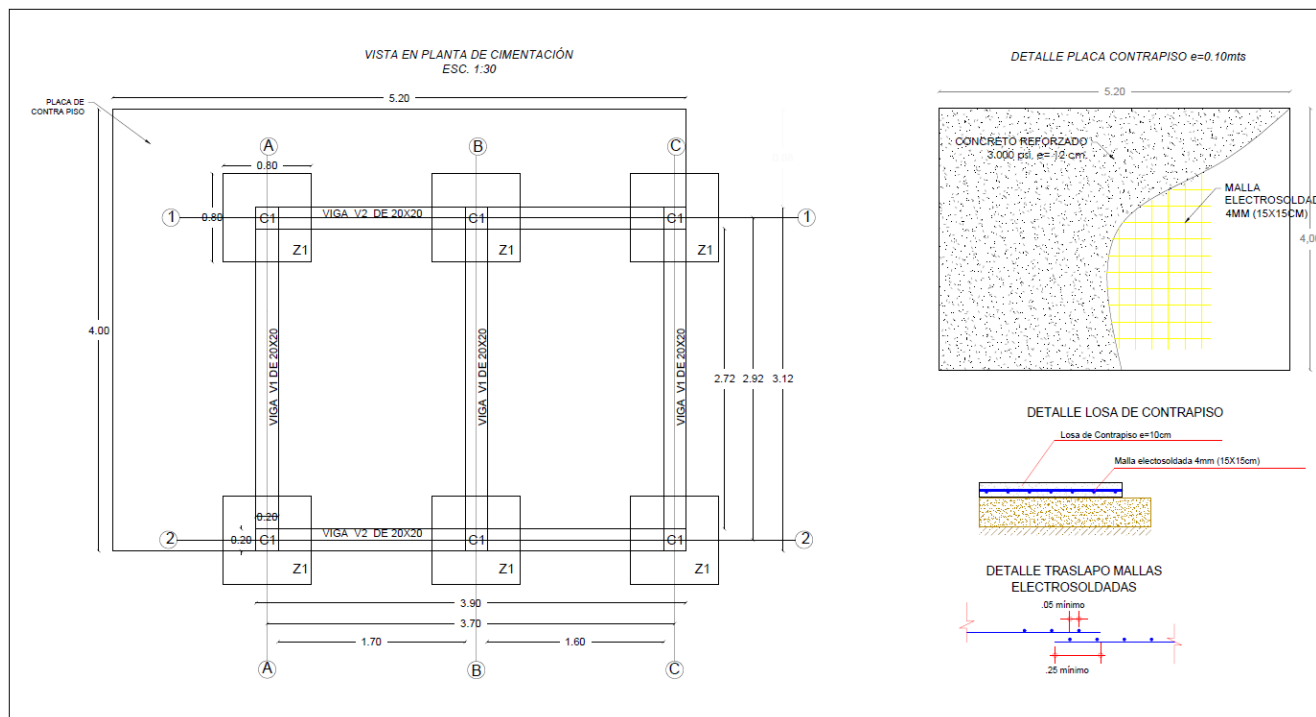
Plano vista en planta cimentaciones y detalle placa de contrapiso de batería sanitaria Casa Cabildo
